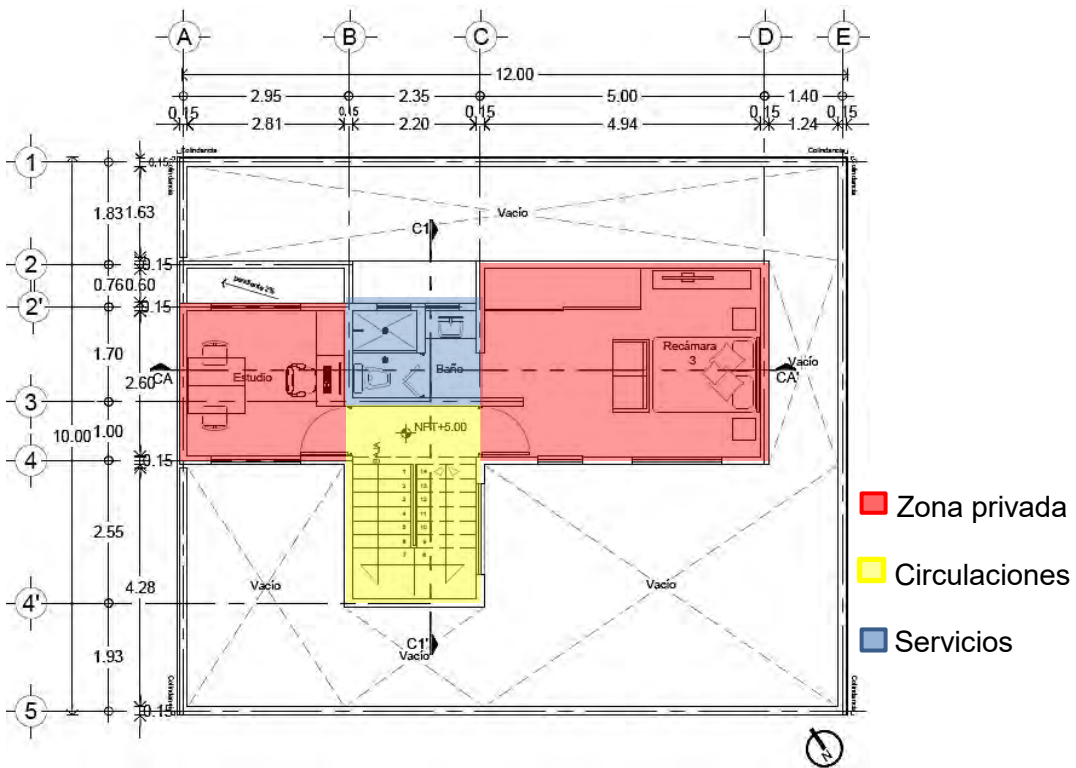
Planta arquitectónica del prototipo de vivienda C2. Tercera etapa, segundo nivel.
